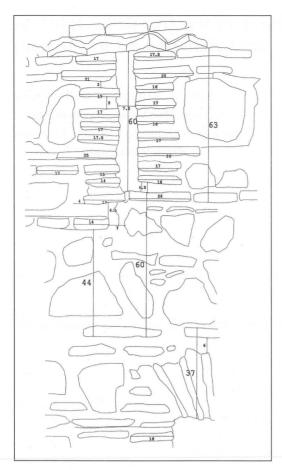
Aparejo toledano en la fachada SE (mihrab)
